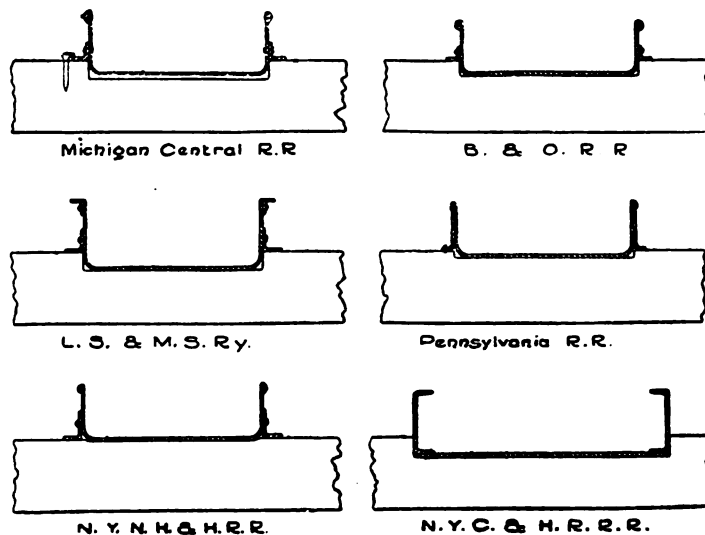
Disposizione del canale d'alimentazione sulle linee americane. - Sezioni.
